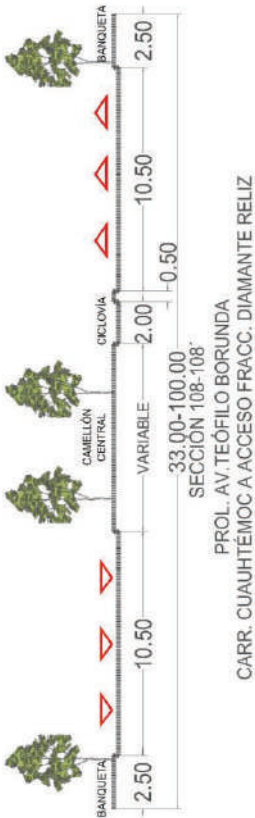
Sección vial Pról. Teófilo Borunda establecida en el Plan de Desarrollo Urbano y en el Plan Parcial 3 Presas.
